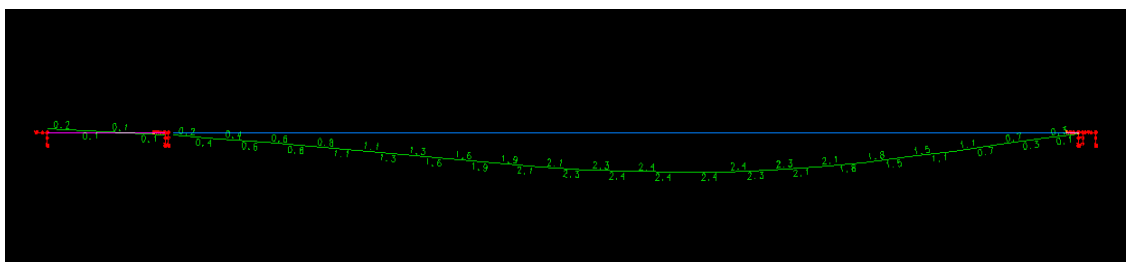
Deslocamentos verticais viga V7 do subsolo, concreto protendido (CAD/TQS).
